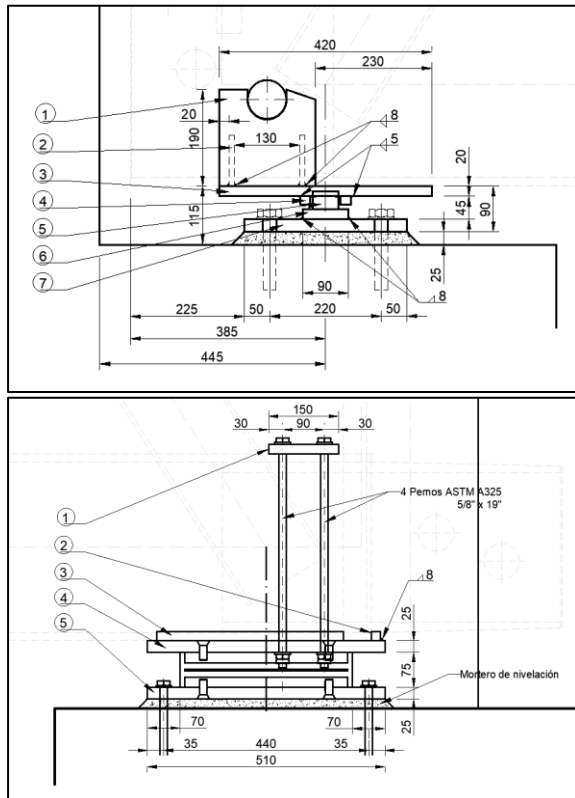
Arriba: Alzado de apoyo fijo. Abajo: Alzado de apoyo móvil.
